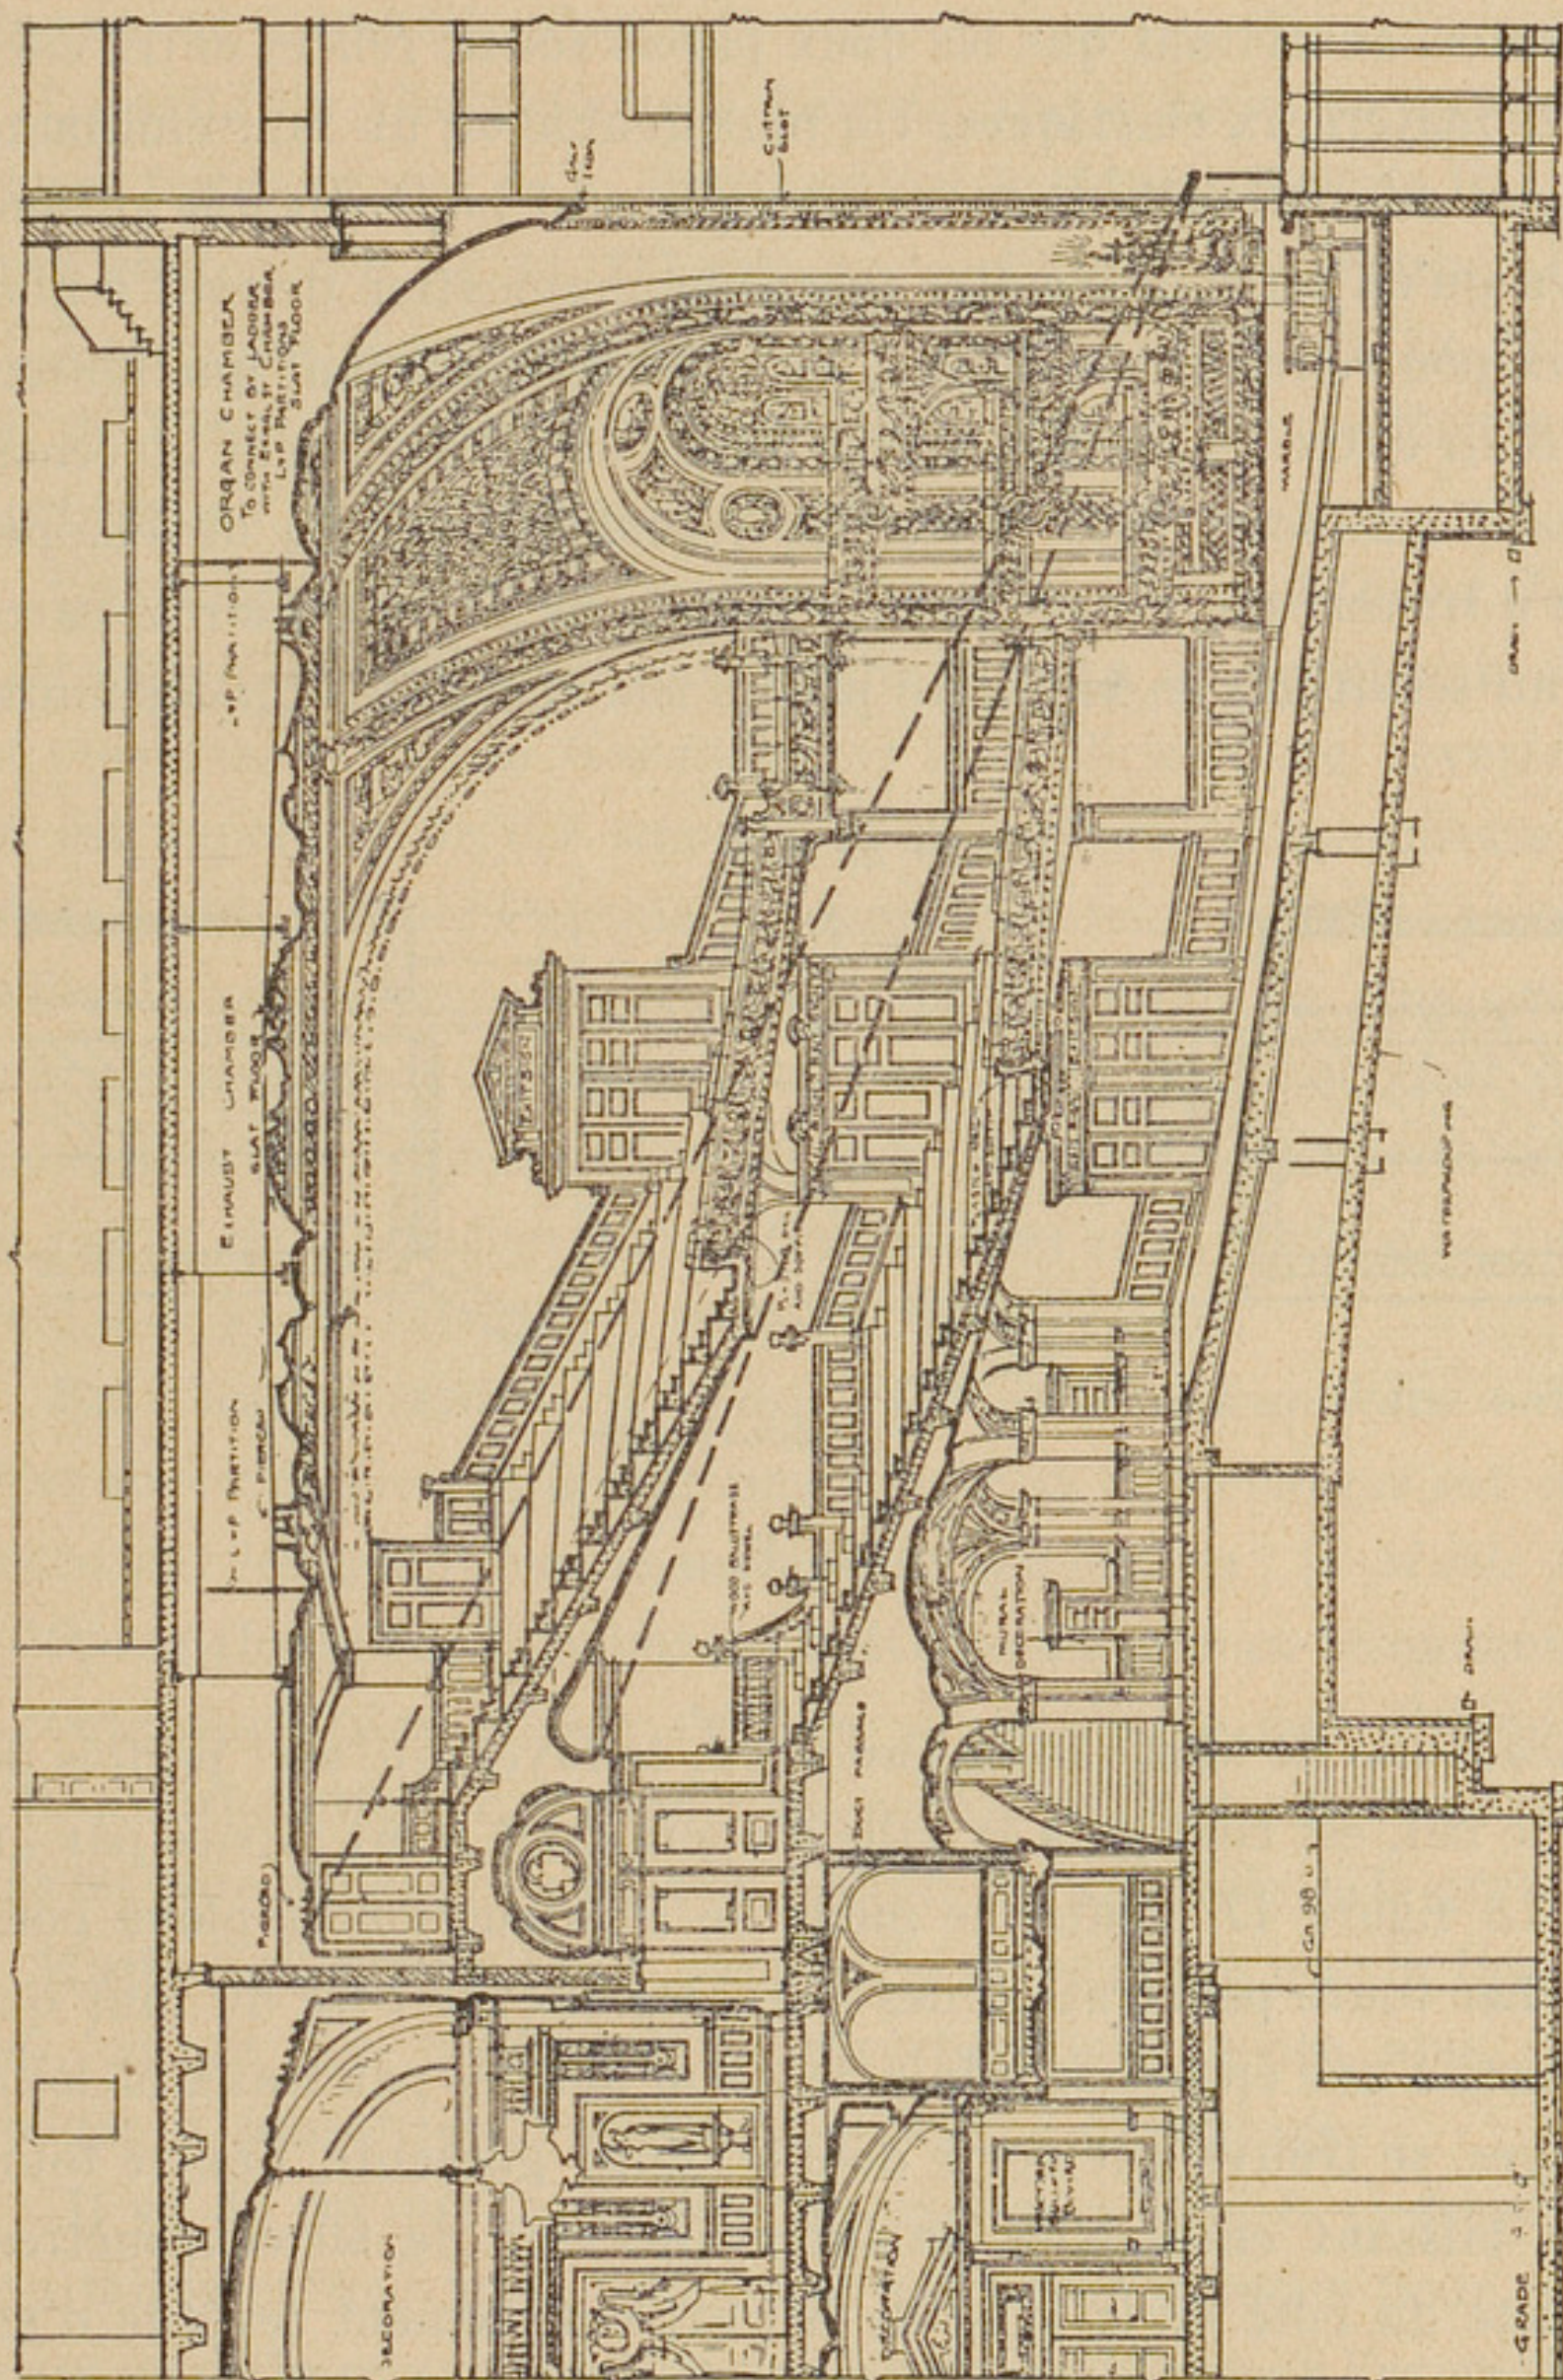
Coupe longitudinale de la salle d'Opéra de la Brooklyn Academy of music.
